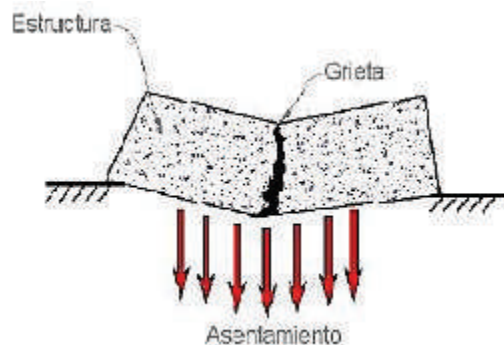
Ejemplo de daño por colapso. Fuente: GEOLAPA.
